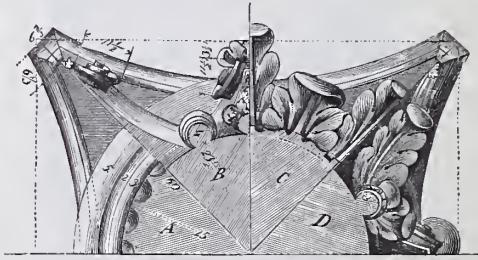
Capital Grundriss zu Fig. 2364.
